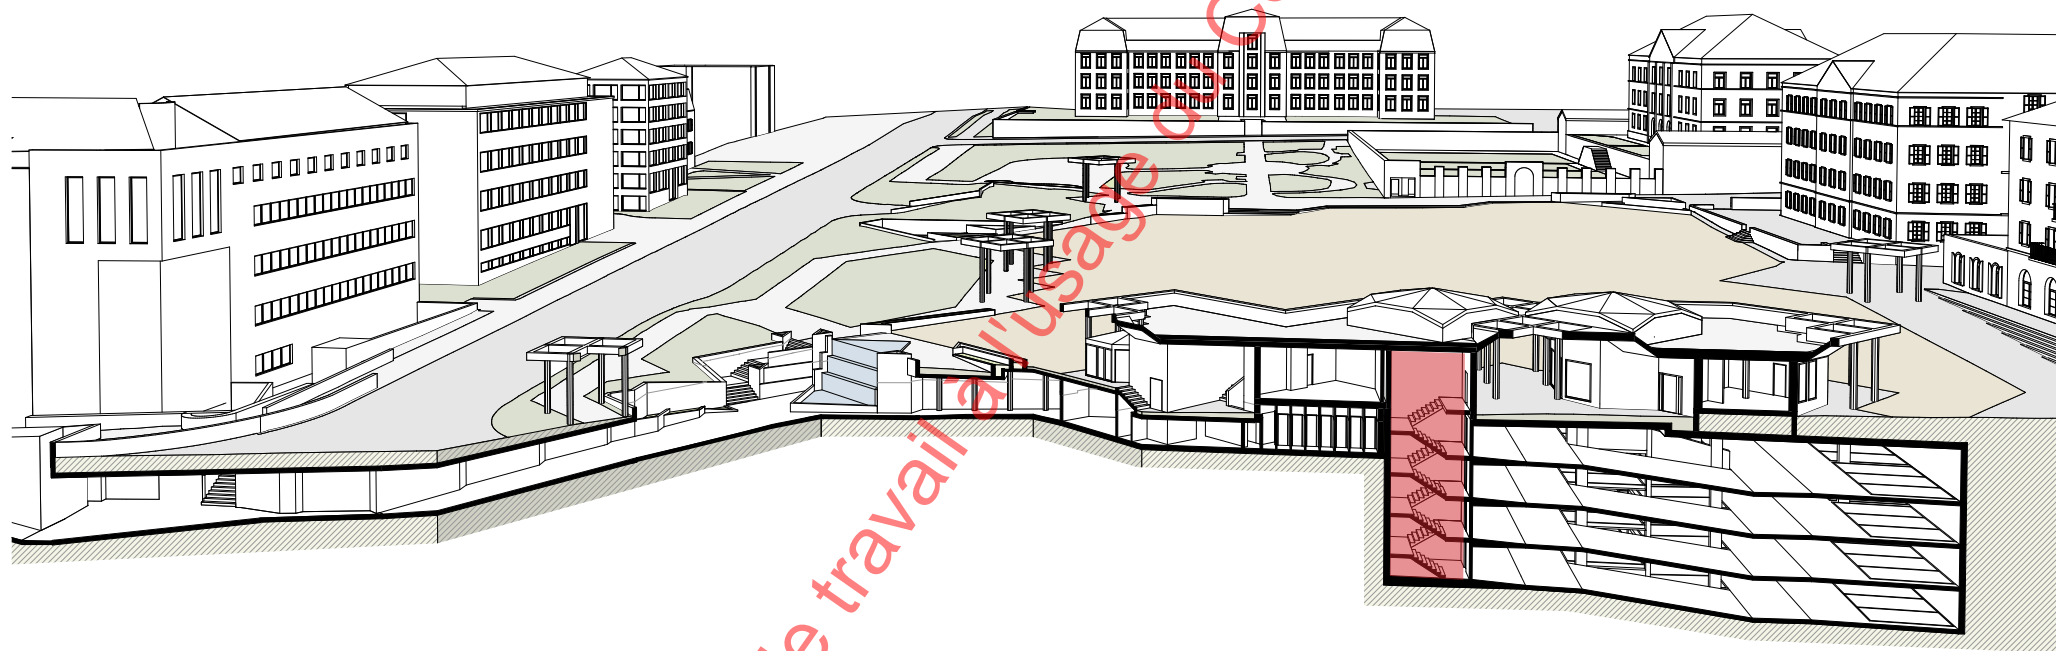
Situation existante - coupe perspective au droit du passage souterrain sud-ouest depuis le parking souterrain à l'est jusqu'au passage sous-voie à la croisée de l'Avenue de la Gare et de la Rue de Lausanne [xy-ar.ch, 2021]
